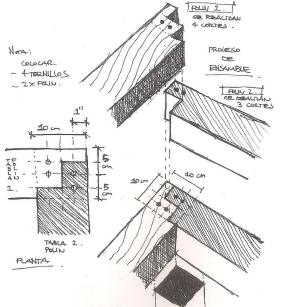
DETALHE CONSTRUTIVO: CON-EXÃO DAS VIGAS (MÓDULO 10X10). FONTE: S-AR (2006)
